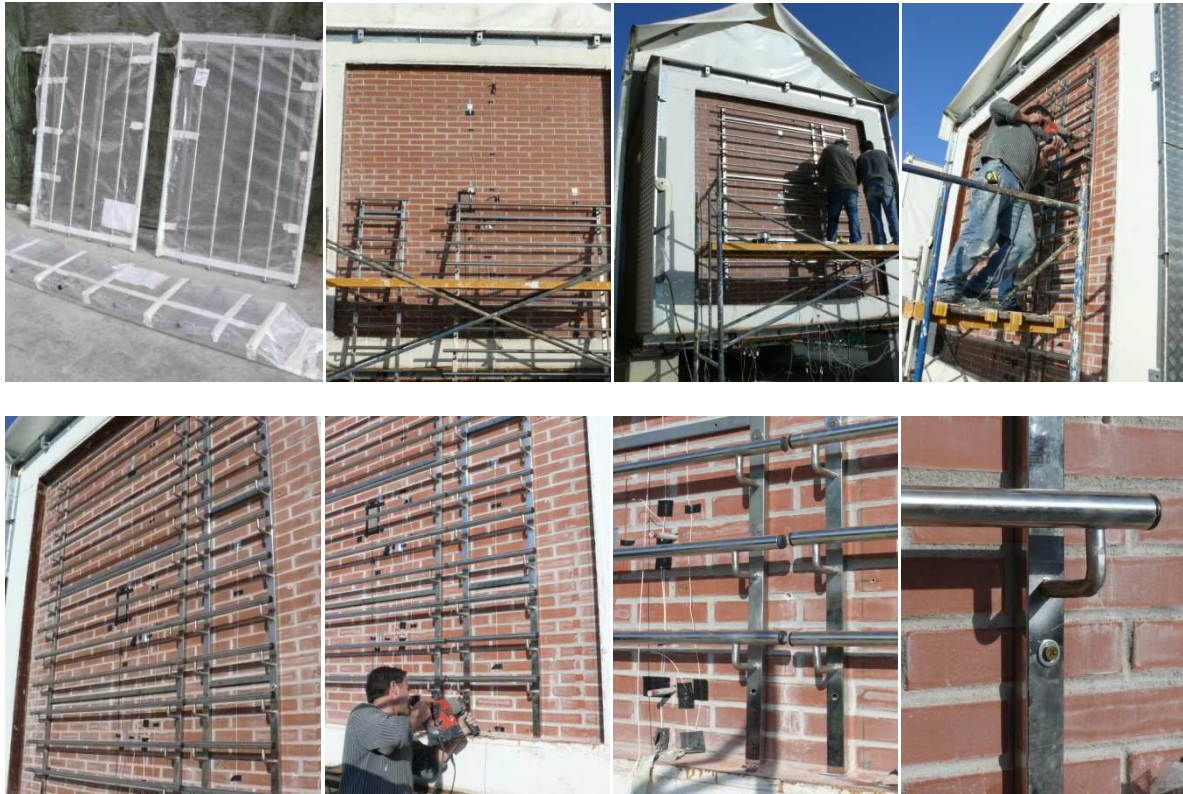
12. Detalle del proceso de montaje de la estructura de anclaje, desde la llegada de la propia estructura metálica hasta su posterior colocación
